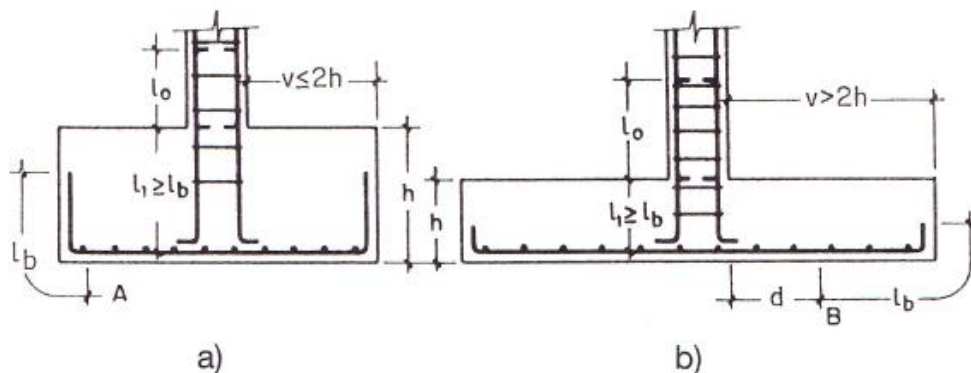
Anclaje de barras en zapatas rígidas a) y flexibles b) (fuente: Jiménez Montoya, 2009)
